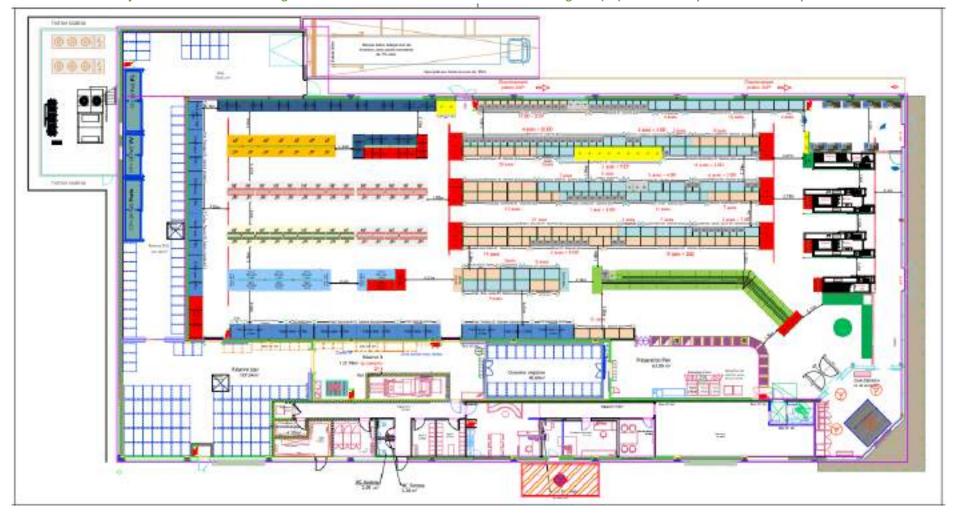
Plan du rez-de-chaussée ; Source : Villesange Masson Architecture
